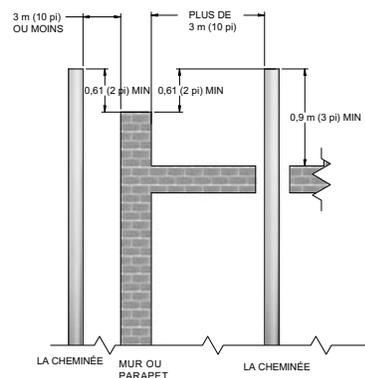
4_ Terminaison de ventilation à 3 m (10 pi) ou moins d'un mur de parapet
